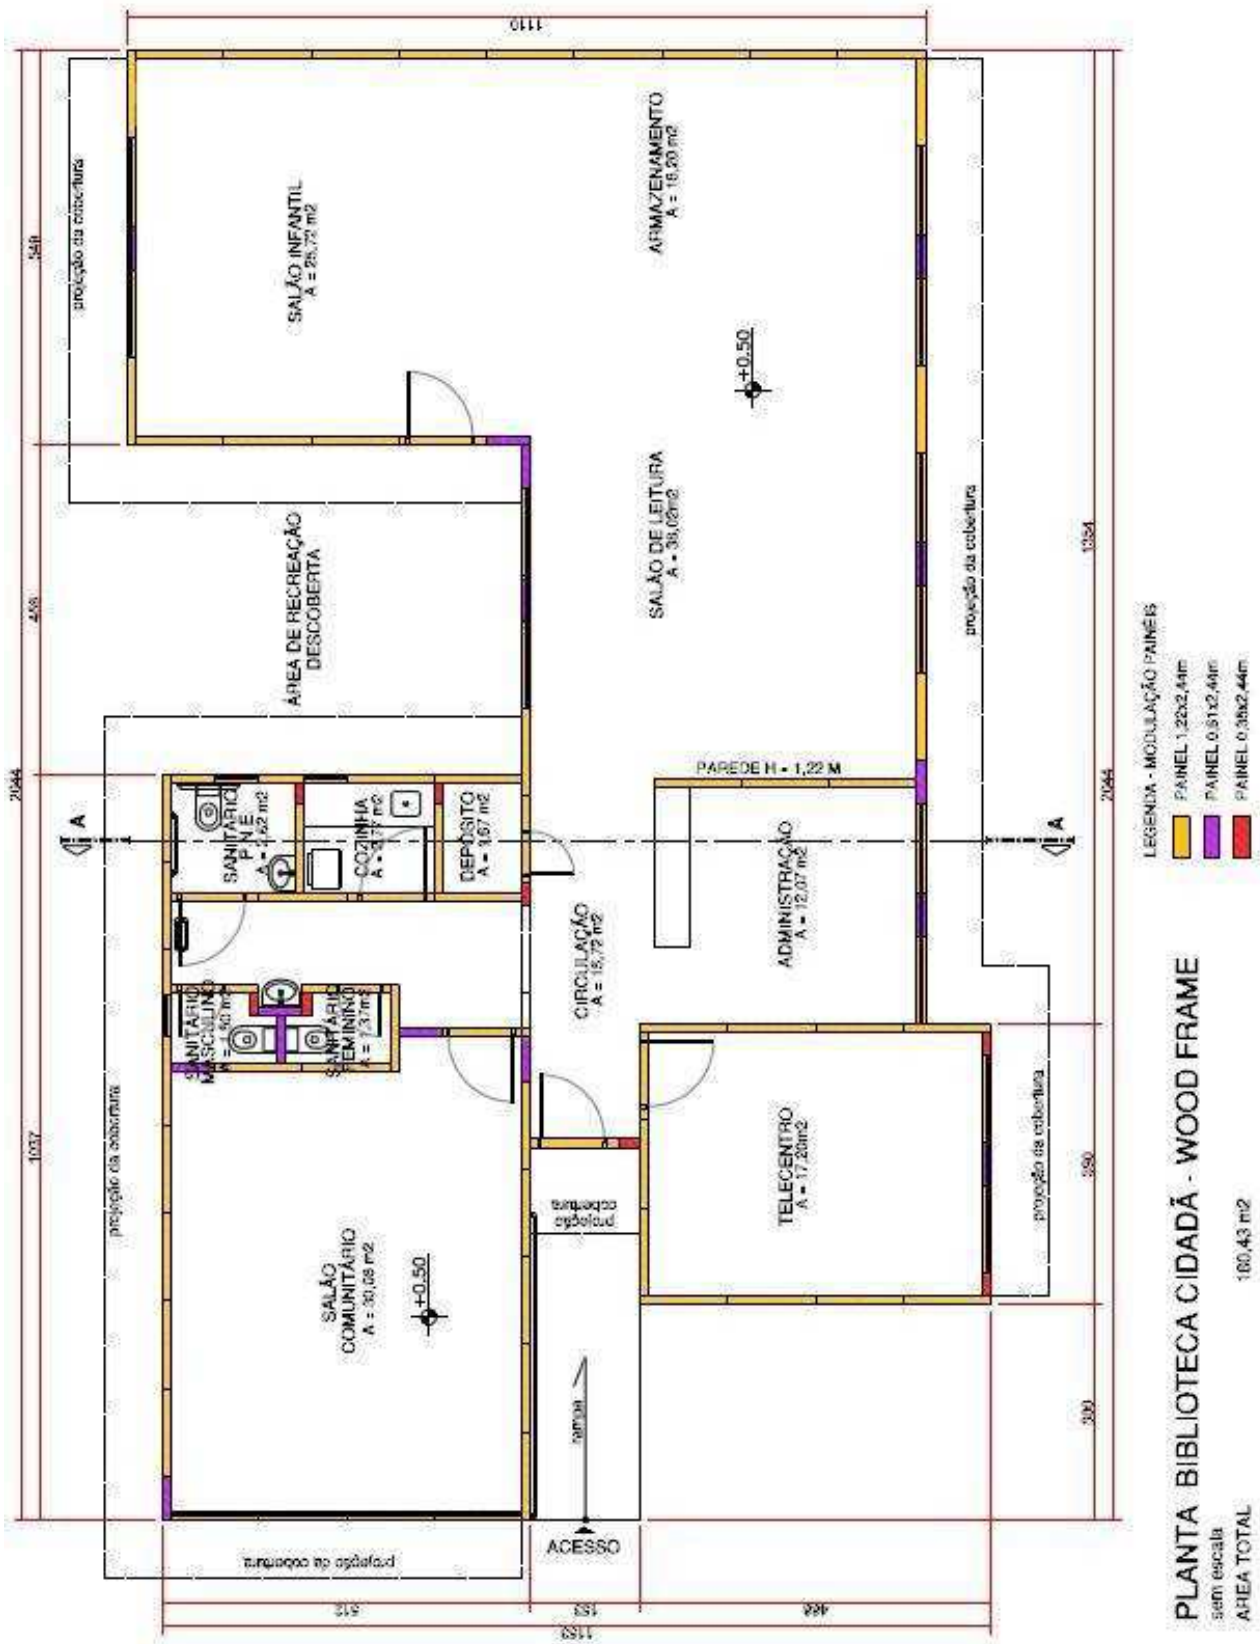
Planta baixa Biblioteca Cidadã em *light wood frame
